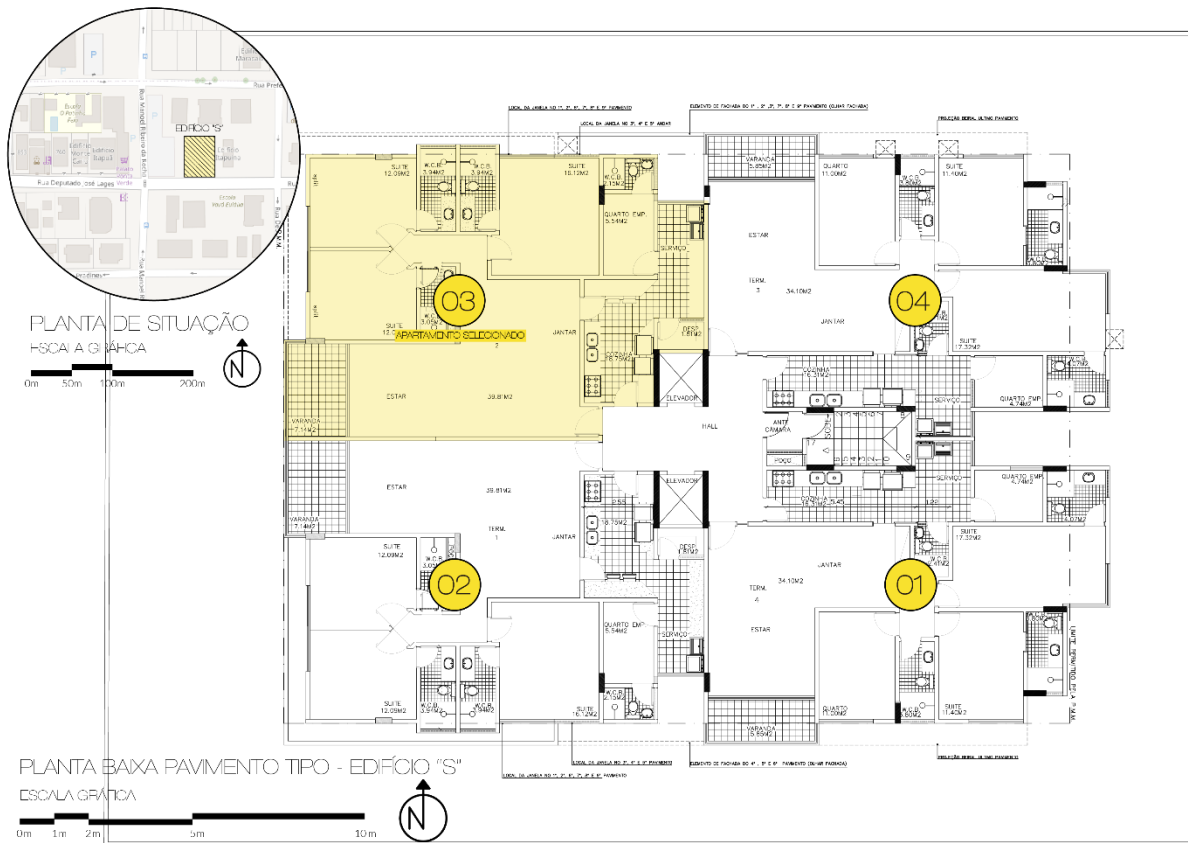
Planta baixa do pavimento tipo. Edifício “S”
